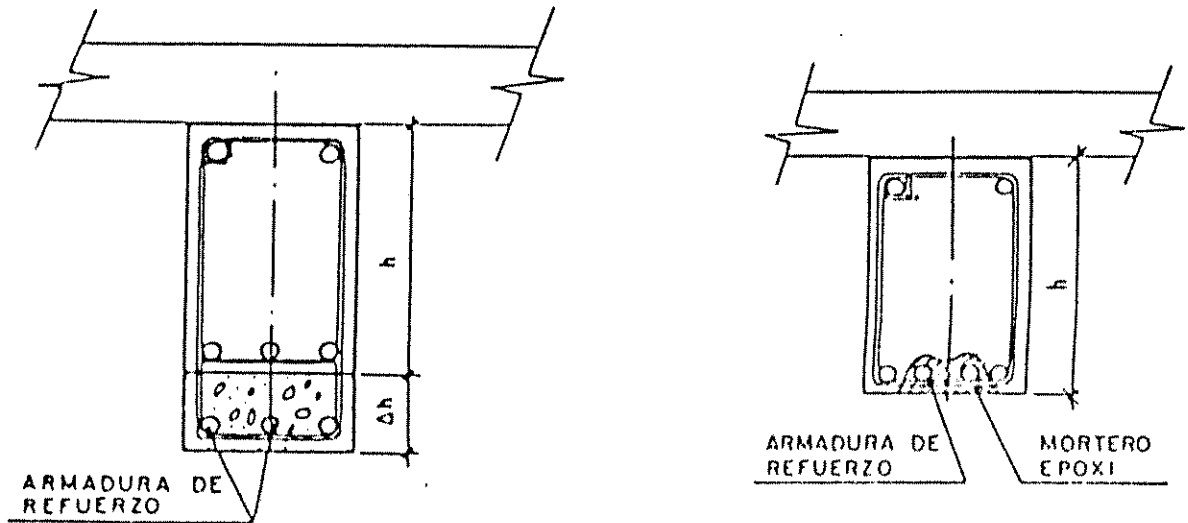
Refuerzo de una viga mediante (A) recrecido de la sección, (B) Mediante acero longitudinal de refuerzo sin recrecido.
